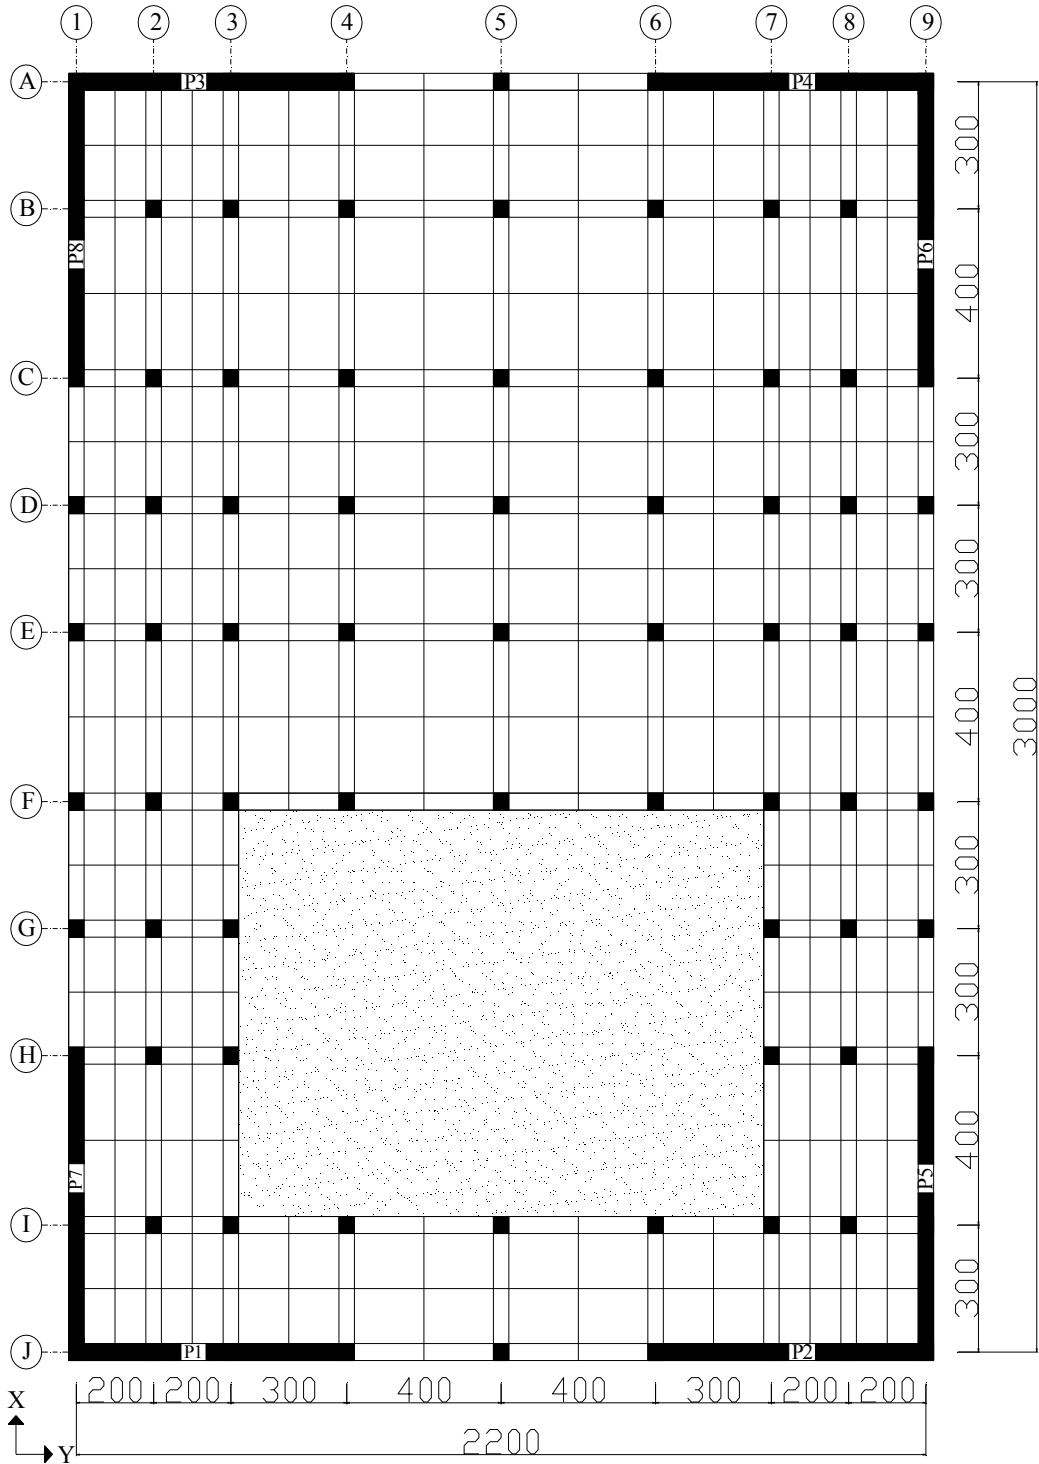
Örnek 6.6'nın kat kalıp planı
